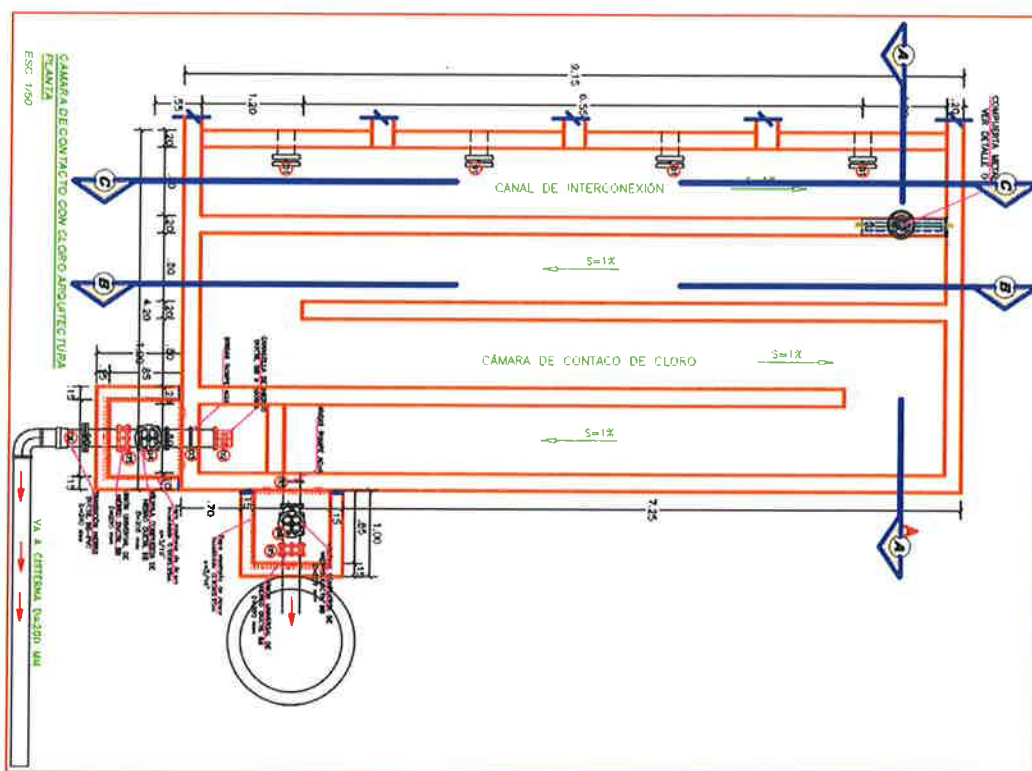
Plano en Planta – Cámara de Contactor de Cloro
